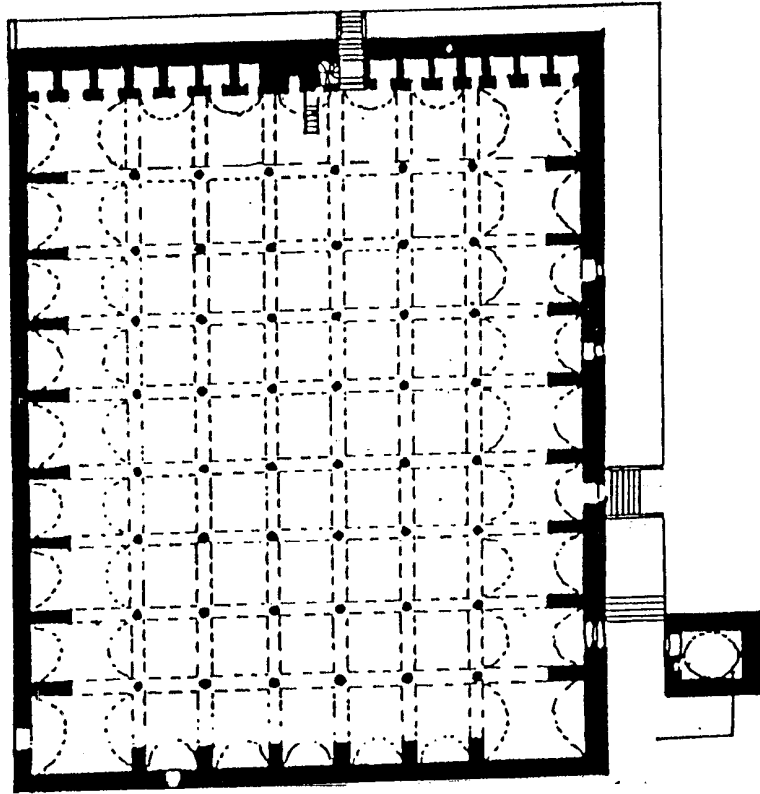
مسقط أفقي لصهيرج الرملة بفلسطين (عن : Creswell)
